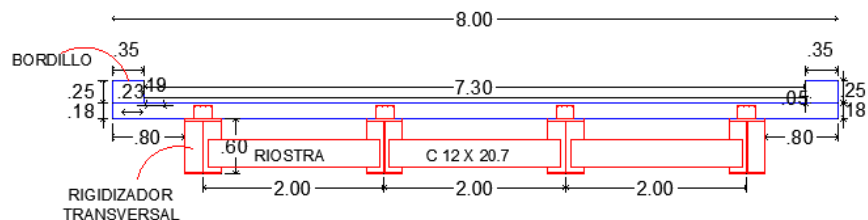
Sección transversal del puente con vigas metálicas de 12 metros. (ver anexo 04 página 01)
